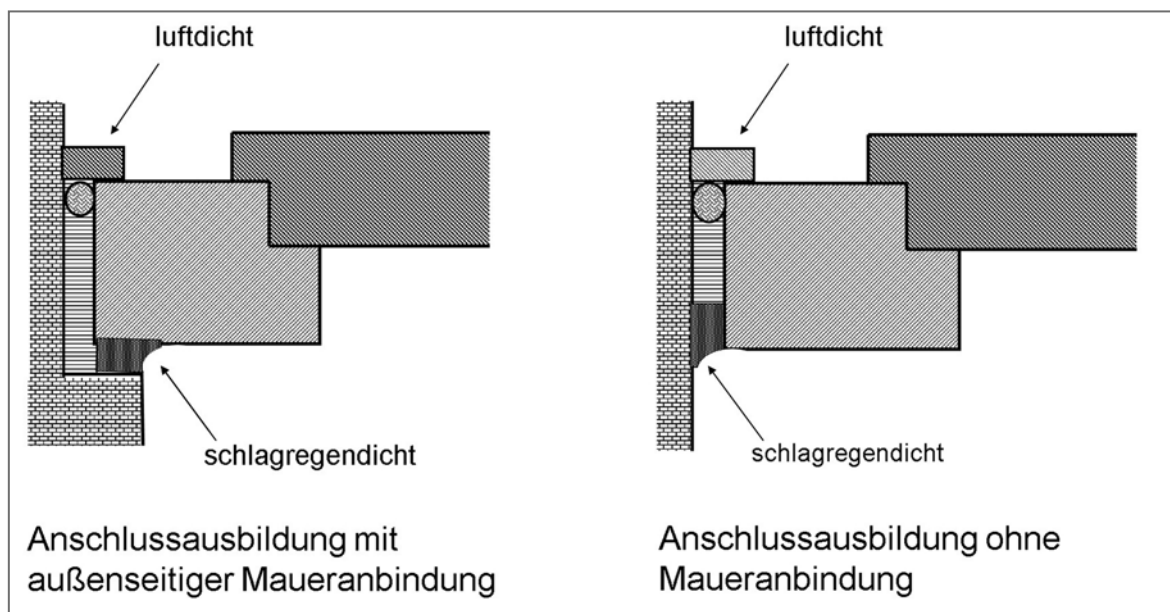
Baukörperanschluss mit Fugendichtstoff
